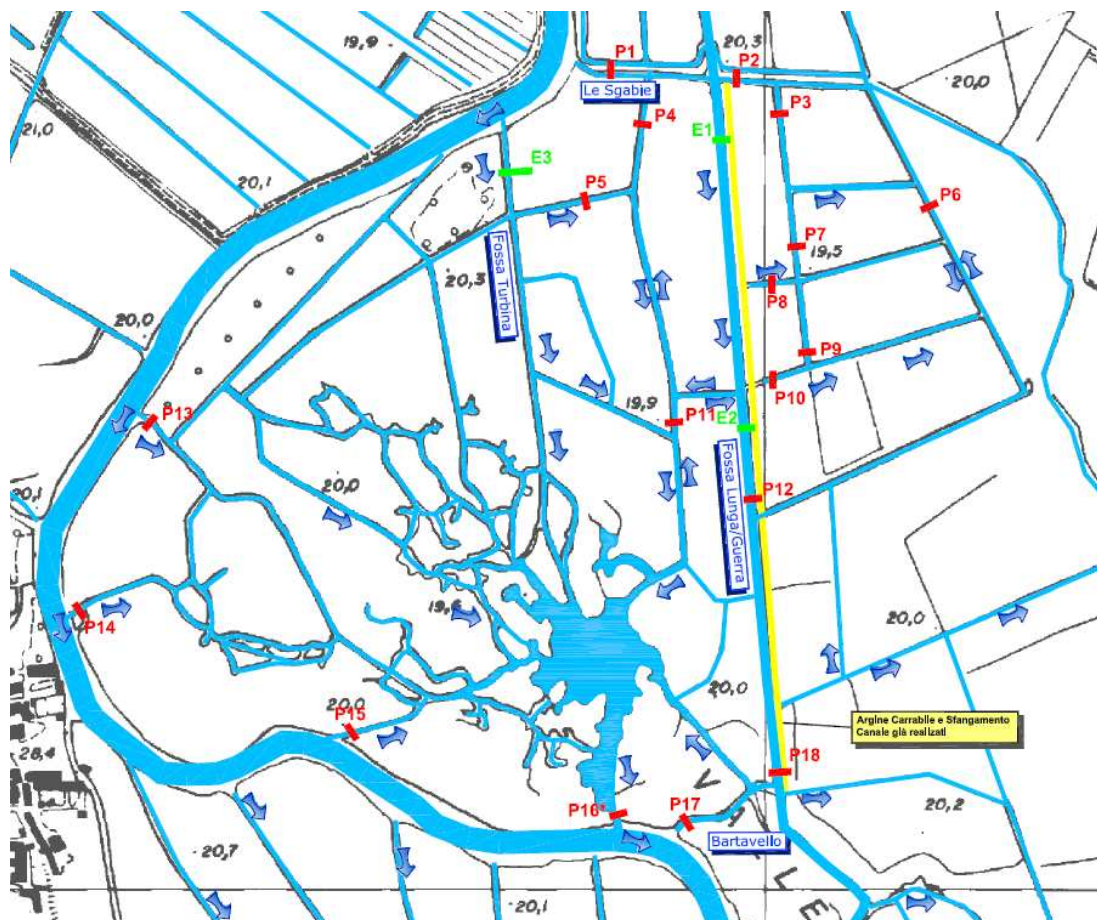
Stralcio della planimetria di progetto definitivo-esecutivo delle opere in appalto previste in comune di Porto Mantovano e legenda.
